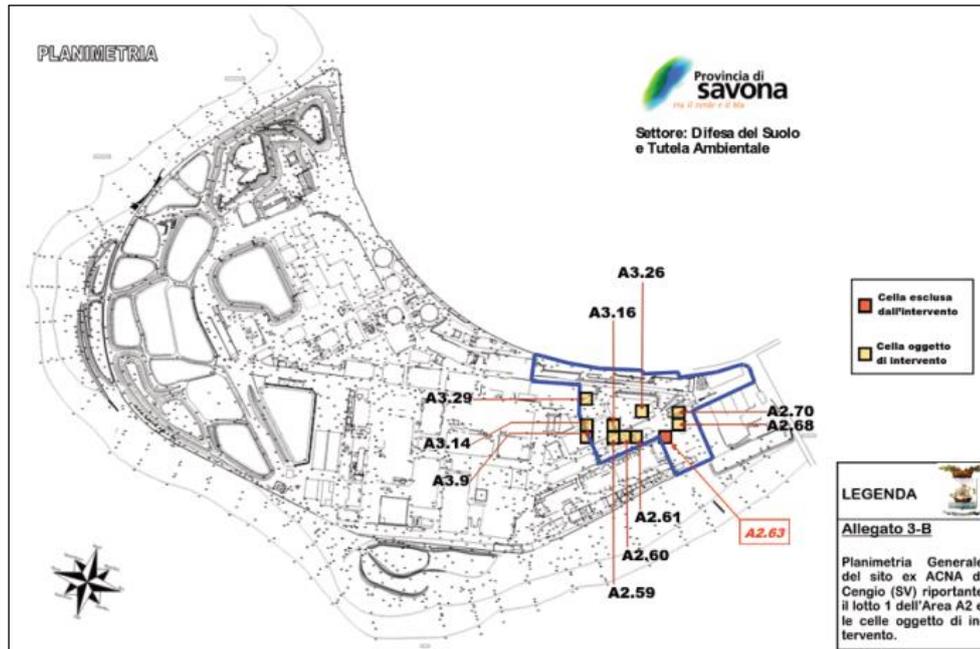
Planimetria Generale del sito ex ACNA di Cengio (SV) riportante il Lotto 1 dell'Area A2 e le celle oggetto di intervento
